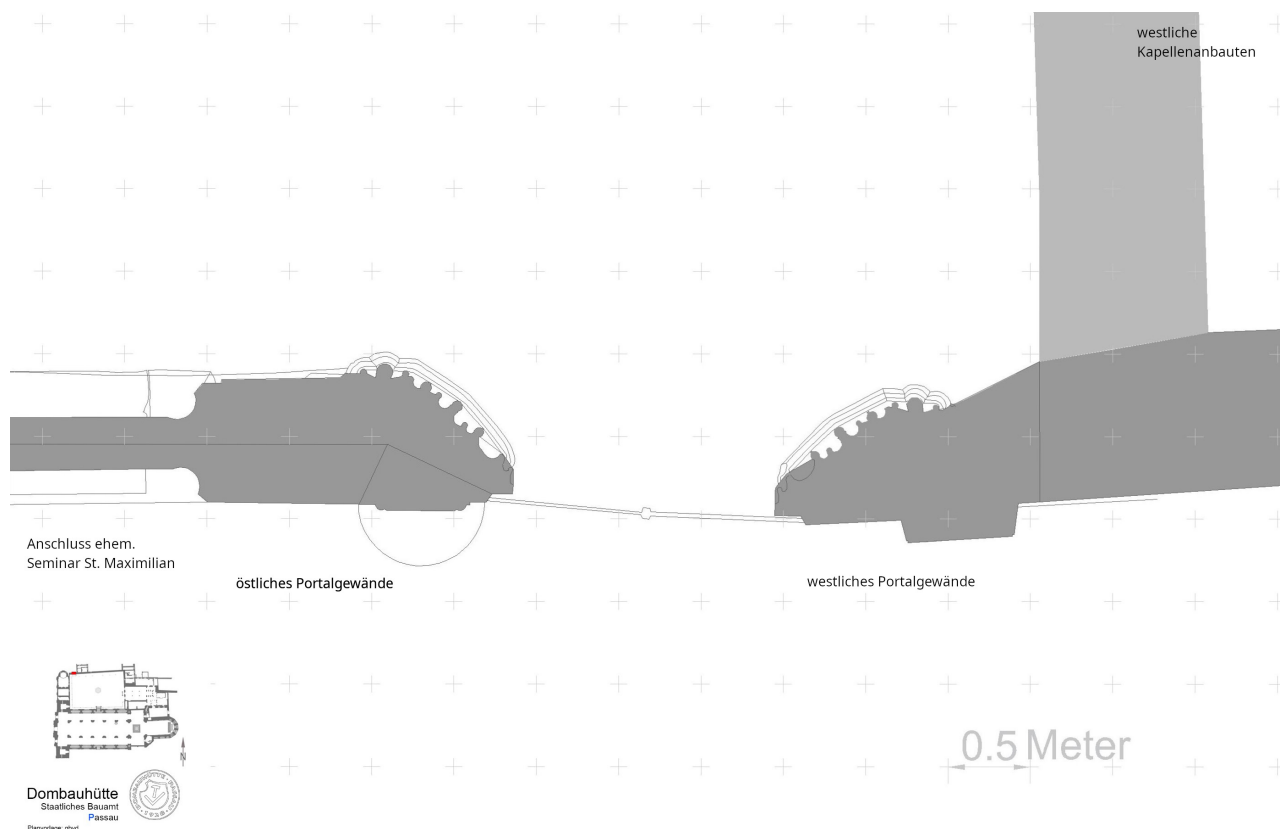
Passau, St. Stephan, ehemaliger Kreuzgang, Grundrissausschnitt der nördlichen Kreuzgangteile mit den Portalgewänden ÄÄ
